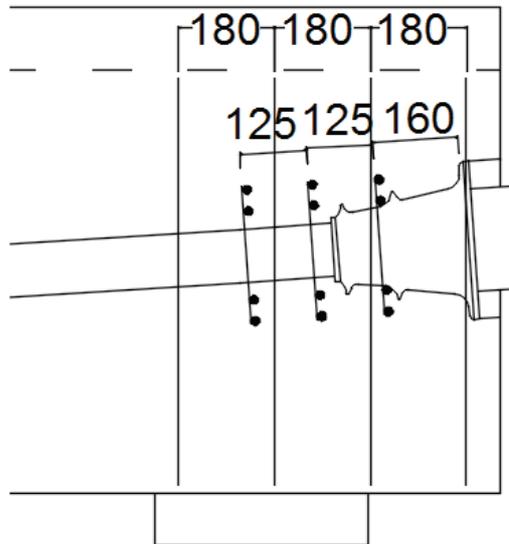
Detalle del anclaje del pretensado (dimensiones en mm)
